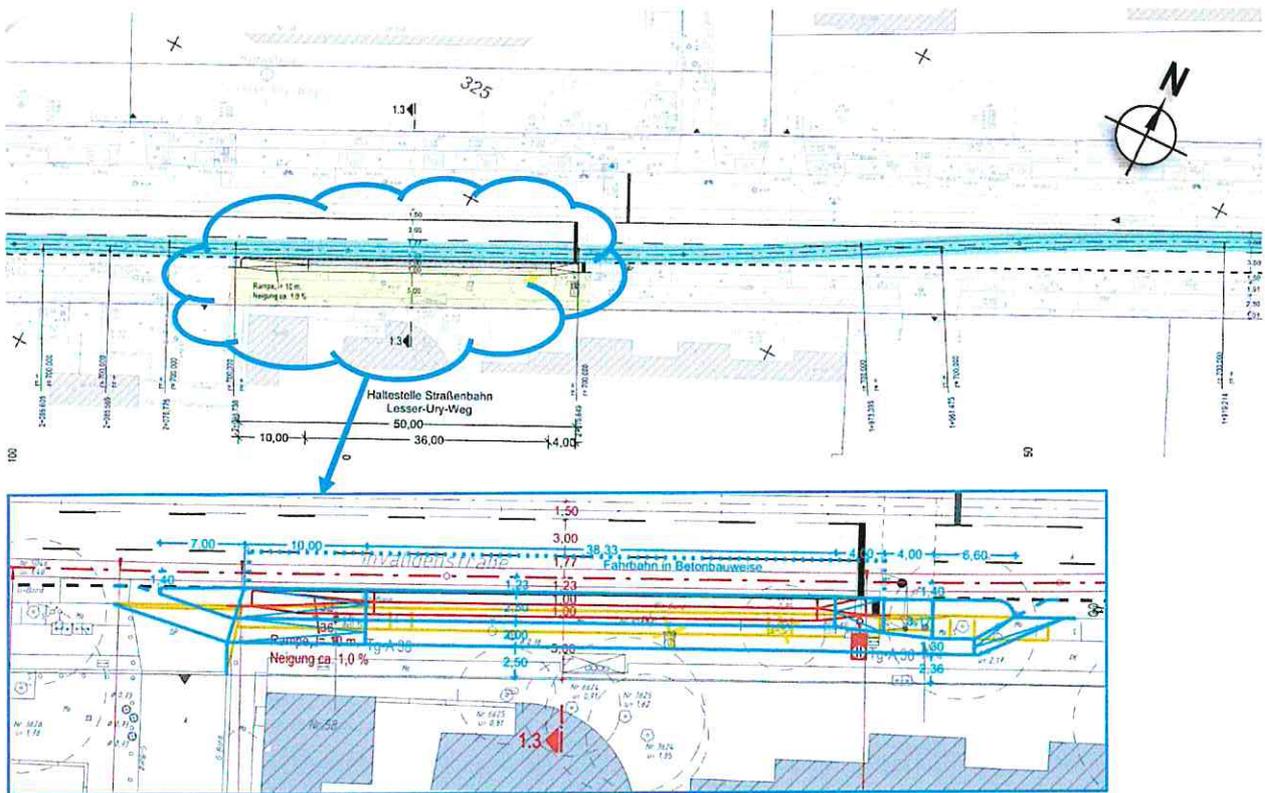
Lageplan Haltestelle Lesser-Ury-Weg mit Radwegführung im Seitenraum
